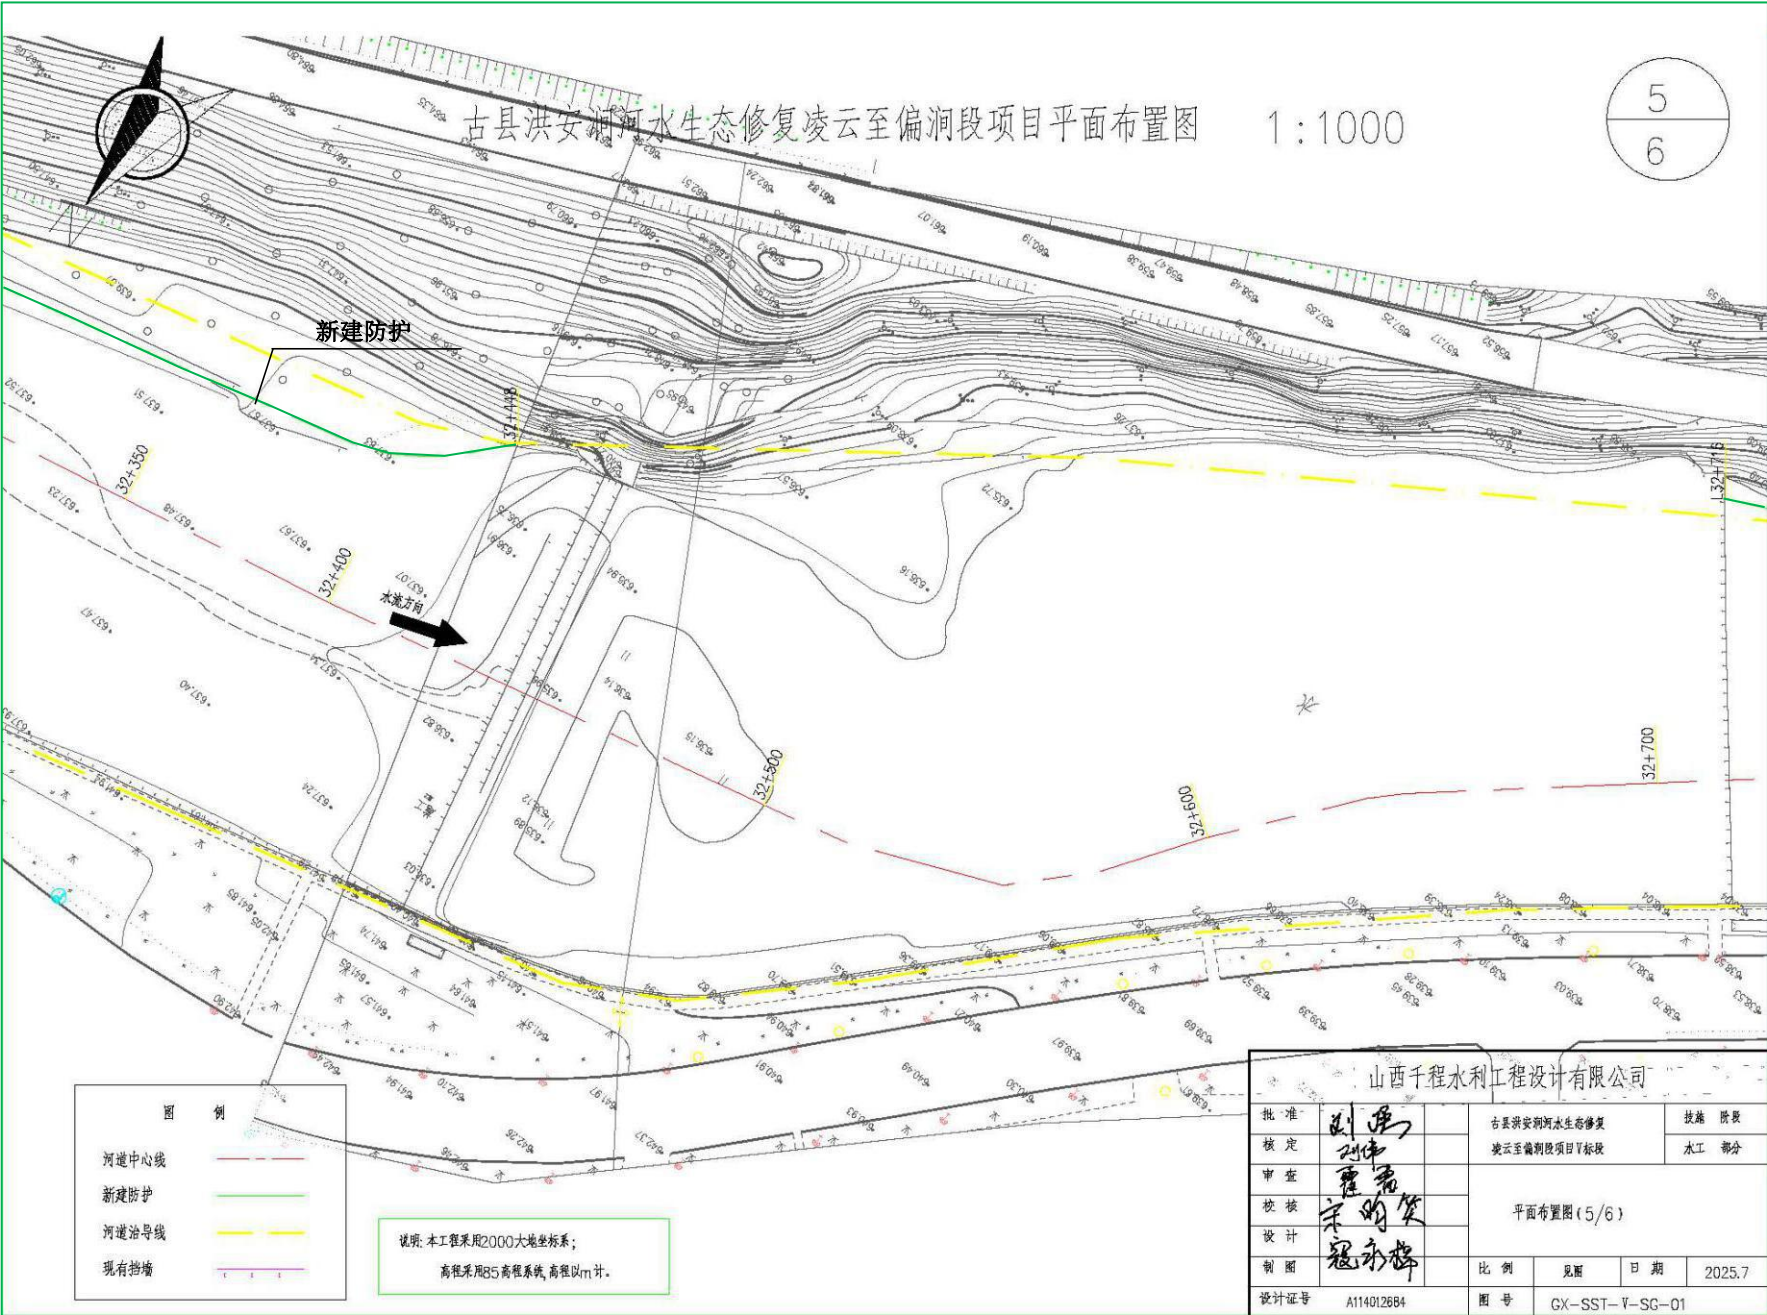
(18) 工程总平面布置图 (桩号 32+300-32+700)
